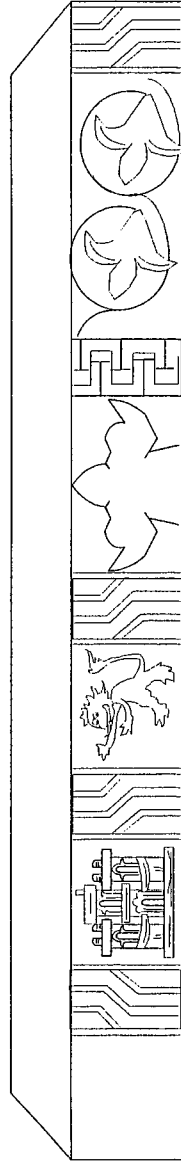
Croquis aproximado de la viga reutilizada para el armado posterior
